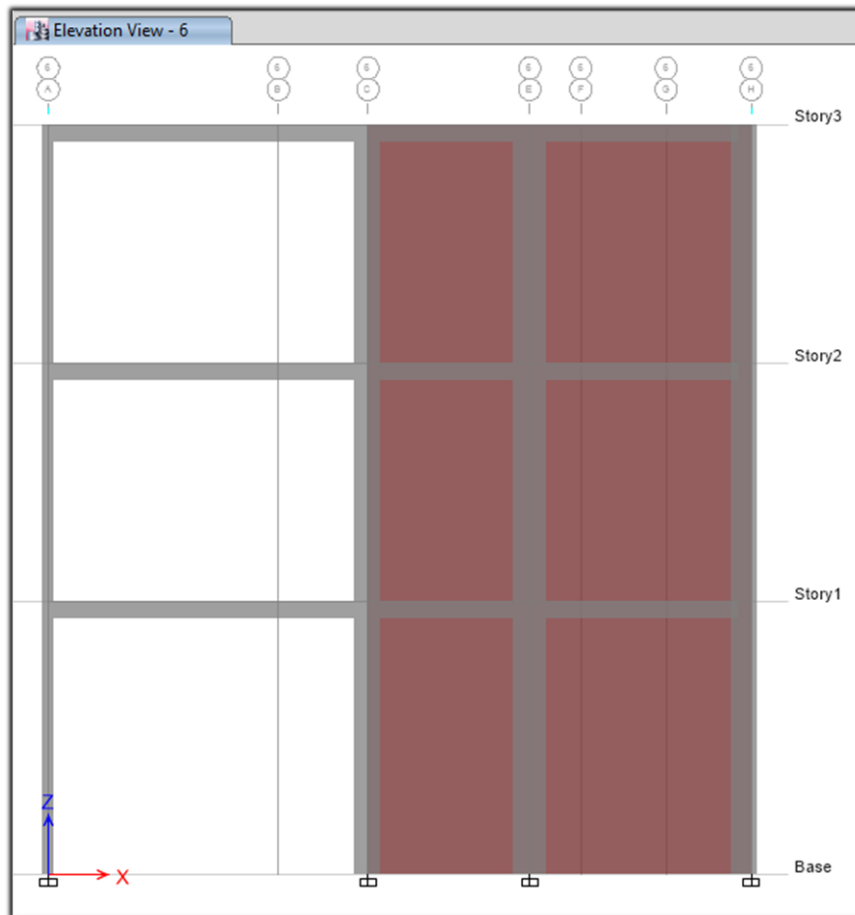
Ubicación y colocación del refuerzo en el eje 6 en X-X
